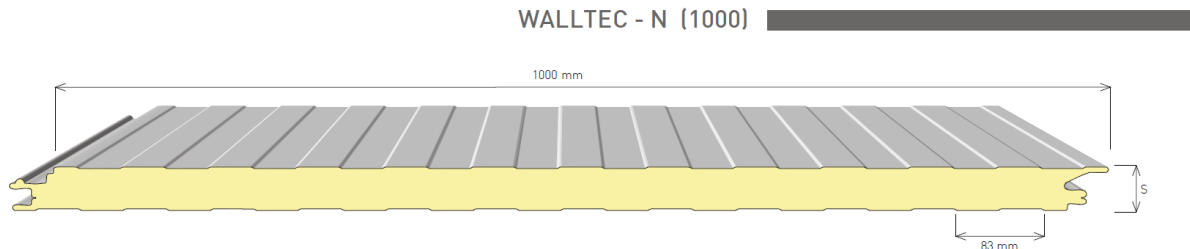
Painéis de WALLTEC - N (1000).(PERFITEC, 2020)
